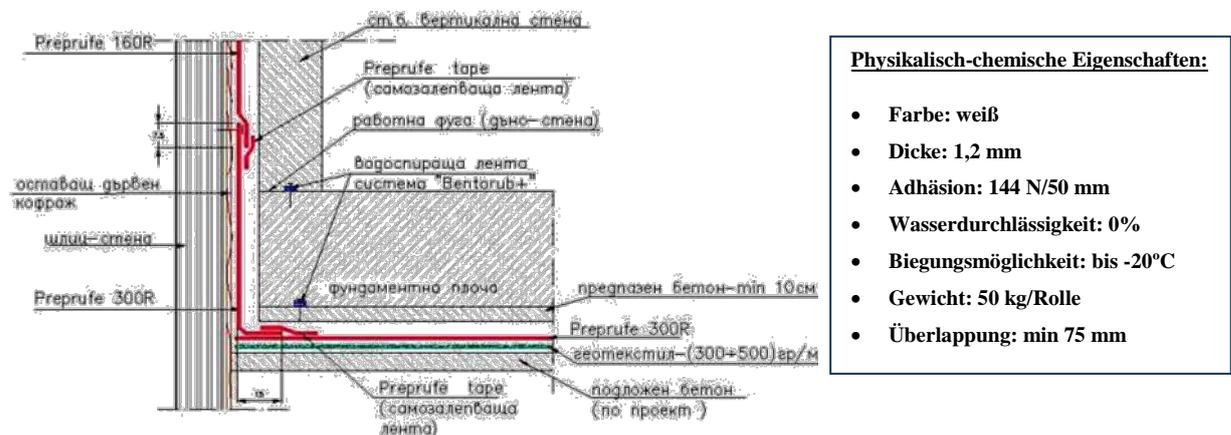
Detail Wand/Sohle: Selbstklebende Abdichtung „Preprufe“ [2.5]
